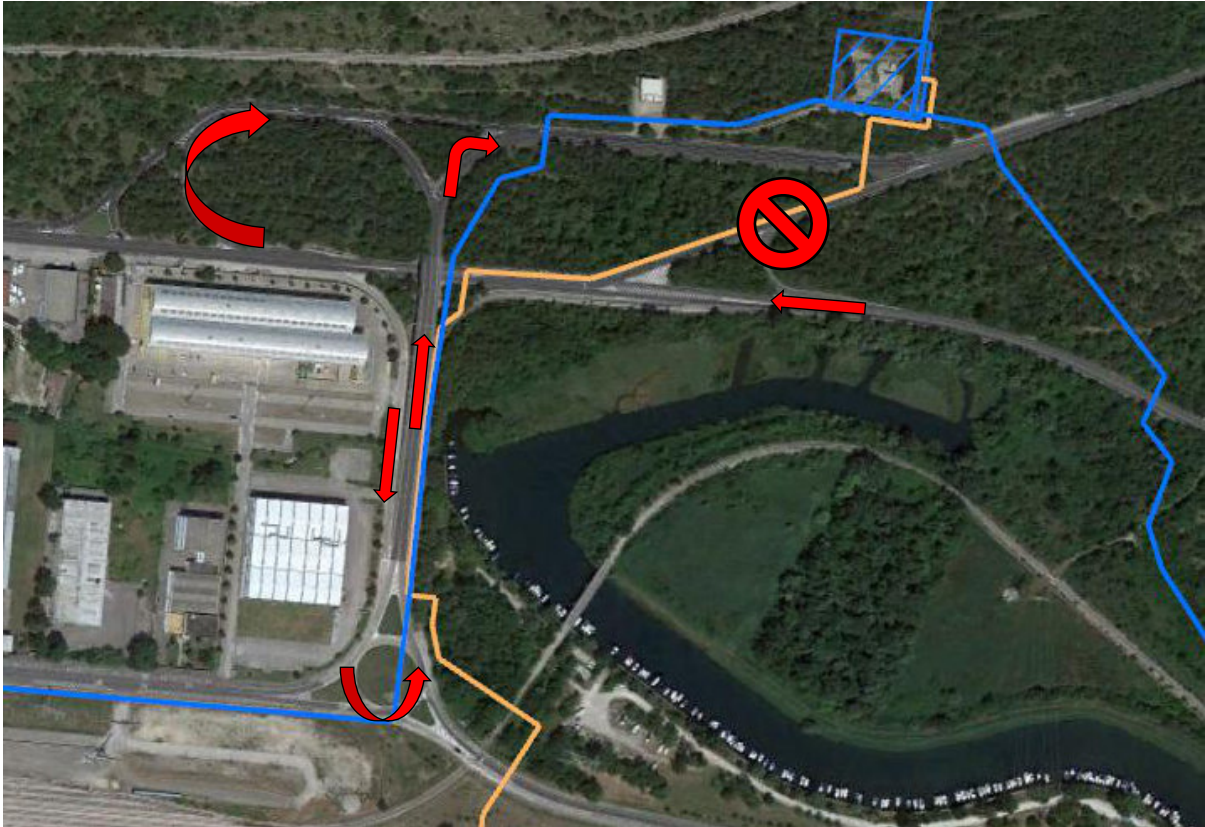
Cantiere 2A – Schema per la deviazione del traffico proveniente da Trieste (direzione)
